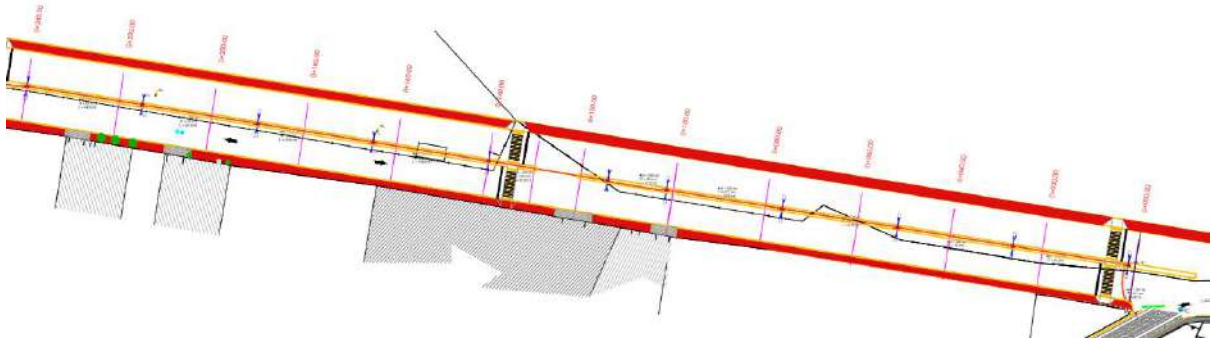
Energía eléctrica calle Viznaga. Planos de alumbrado de la calle.
